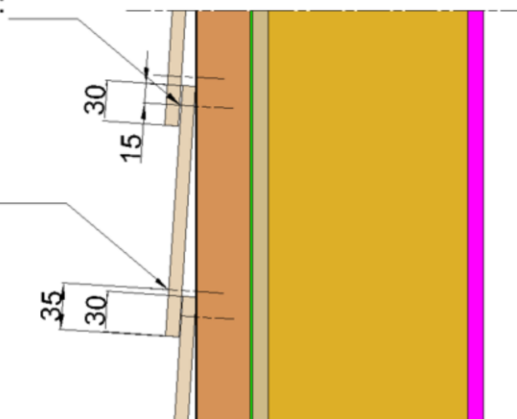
Fixation Rive haute de la lame CEDRAL LAP - Pose horizontale
